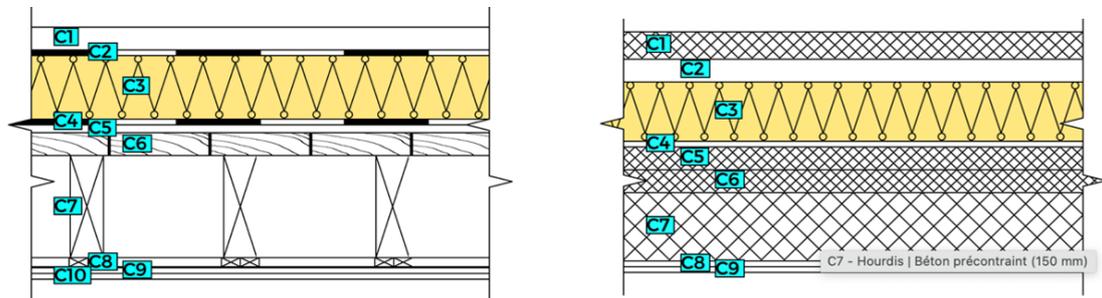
Toiture gravillonnée nommée Toiture Plate 26, à gauche, et toiture en carreaux de béton intitulée Toiture Plate 21, à droite (TOTEM)
